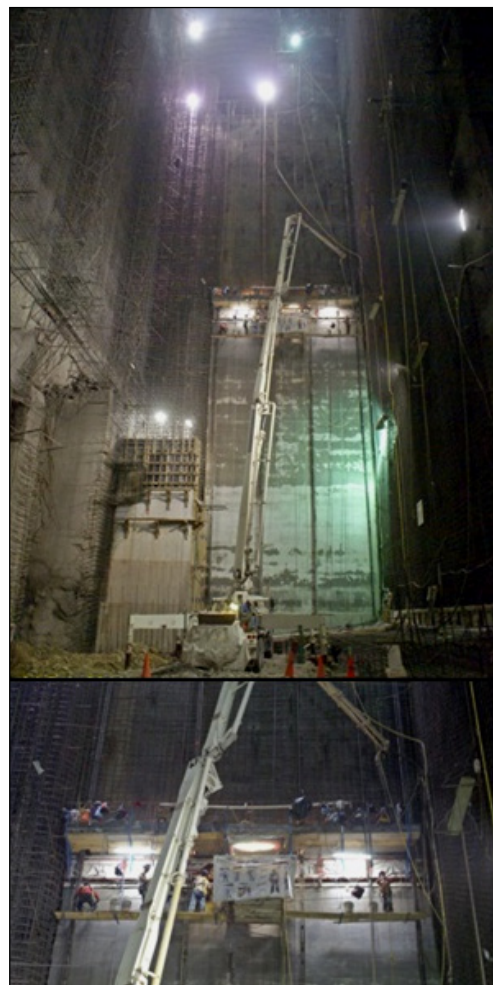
Cimbra deslizante, utilizada para el revestimiento de los muros en la caverna de Galería de Oscilación, en la construcción de la C. H. La Yesca.
